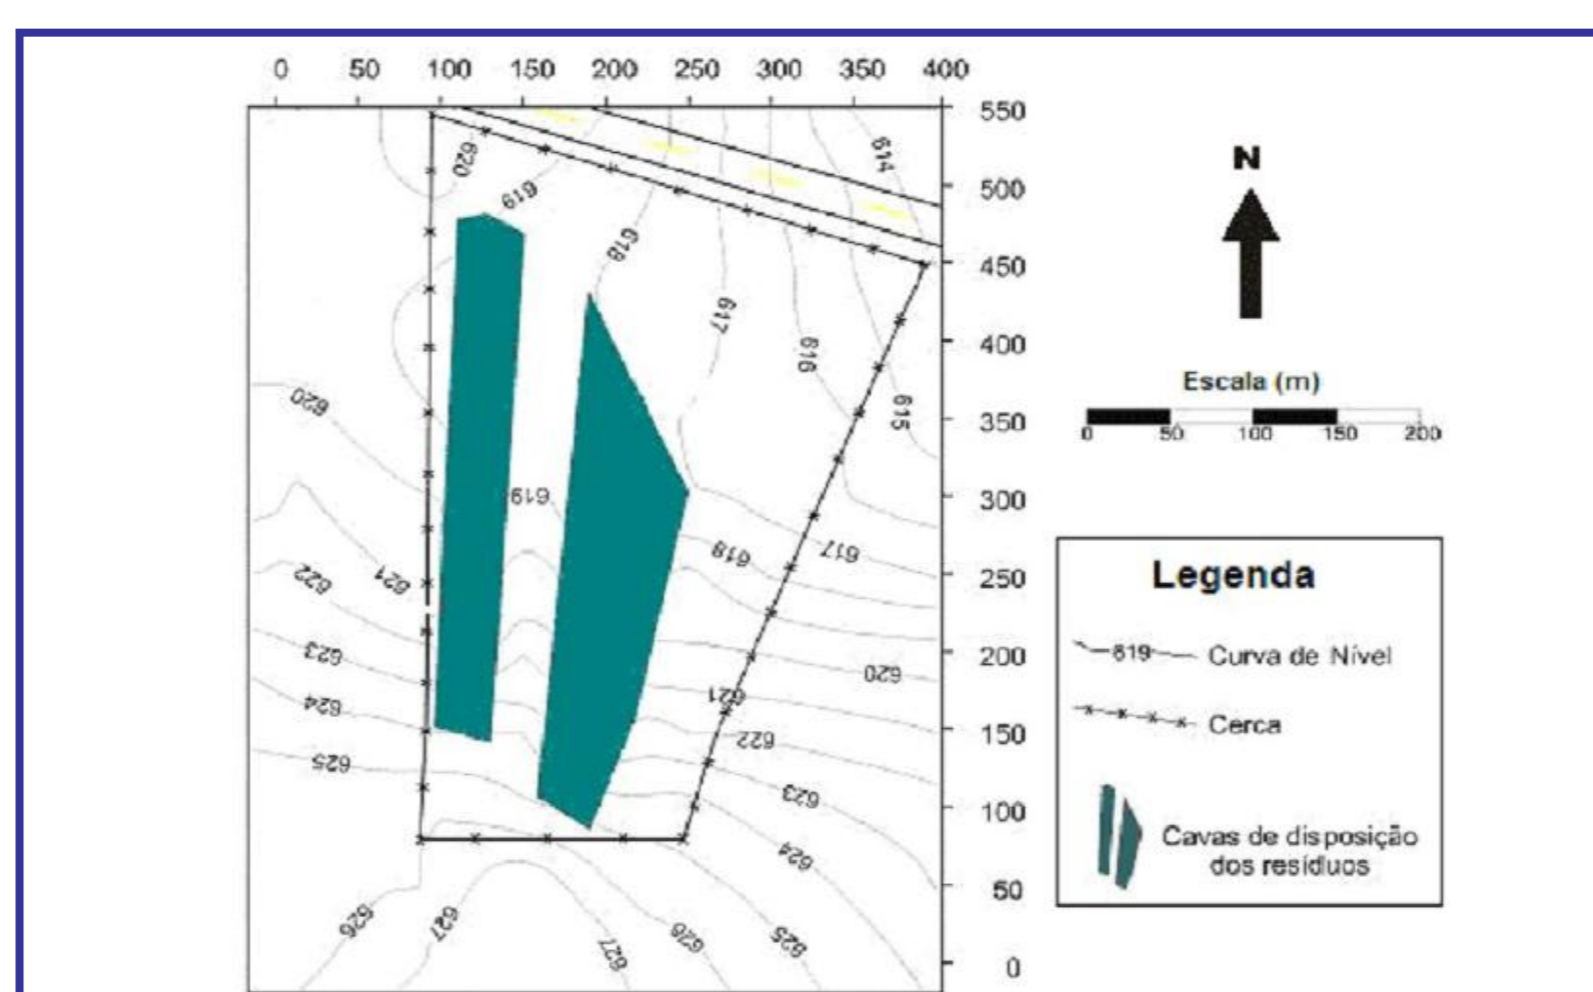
Planta da área e a disposição das cavas no terreno (Souza, 2007).
